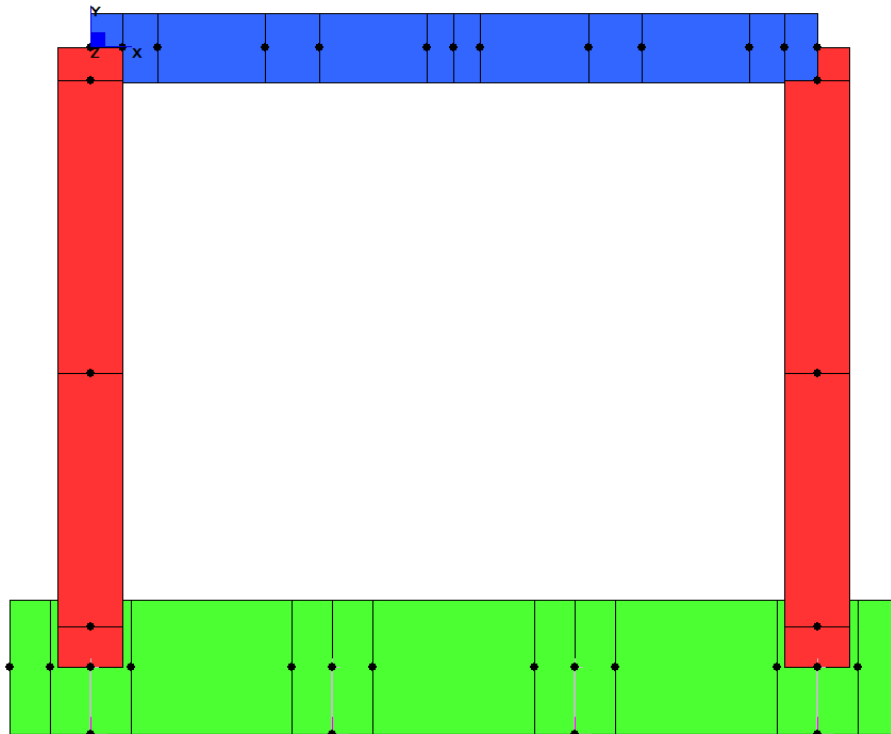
Modello trasversale spalla – Vista solida sezioni strutturali
